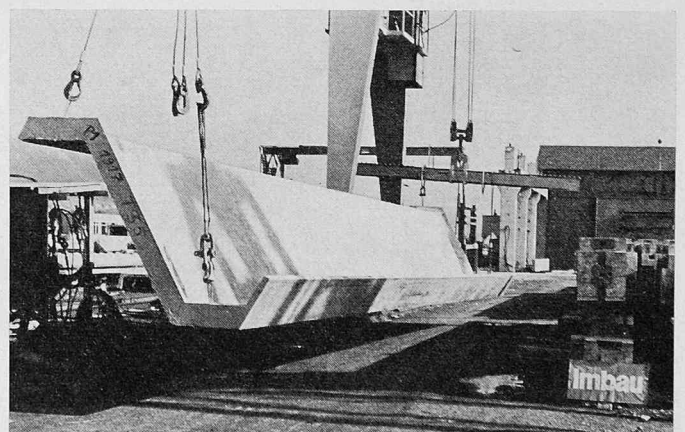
Montage von dreigeschossigen Aussenwänden zum Verwaltungsbau
